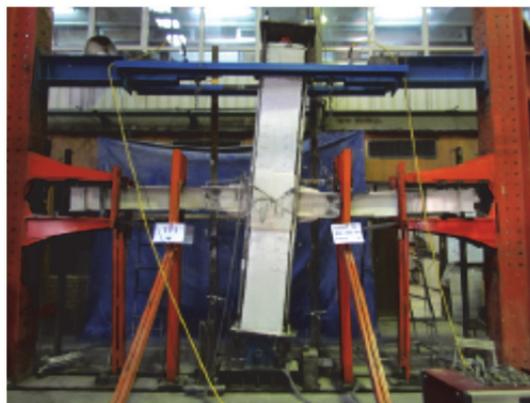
Разрушающие испытания сварного фланцевого узла опирания балок [Fig. 10. Destructive testing of a welded flange support unit for beams] [38]
